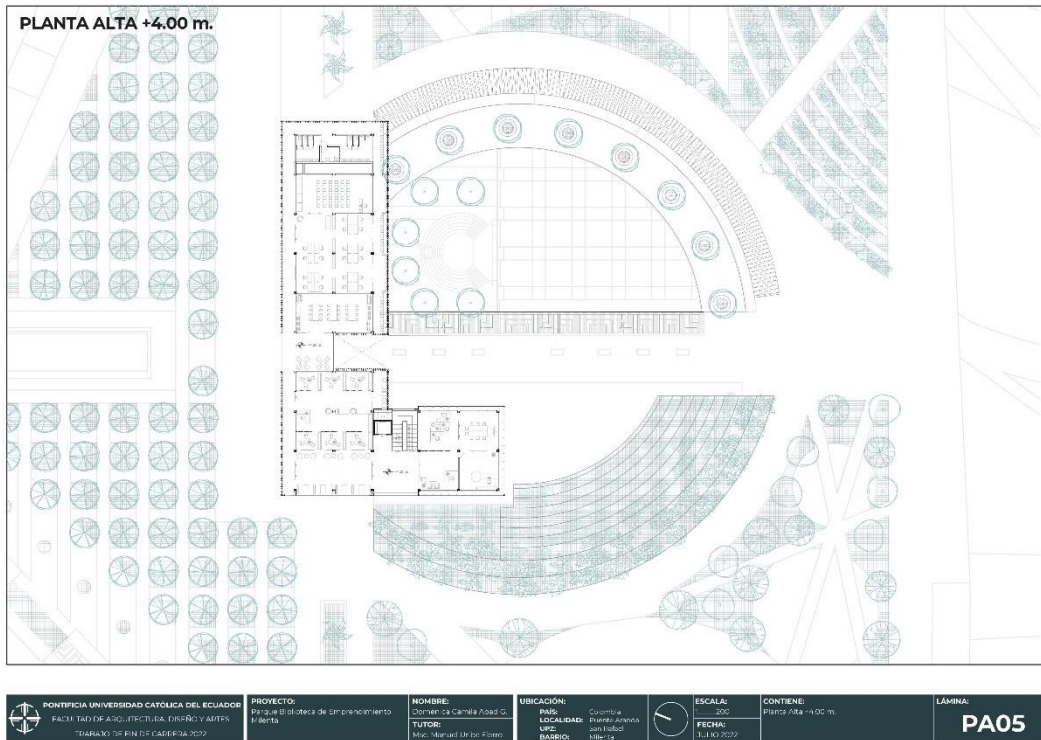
Planta Alta +4.00m (Abad,D. 2022)
